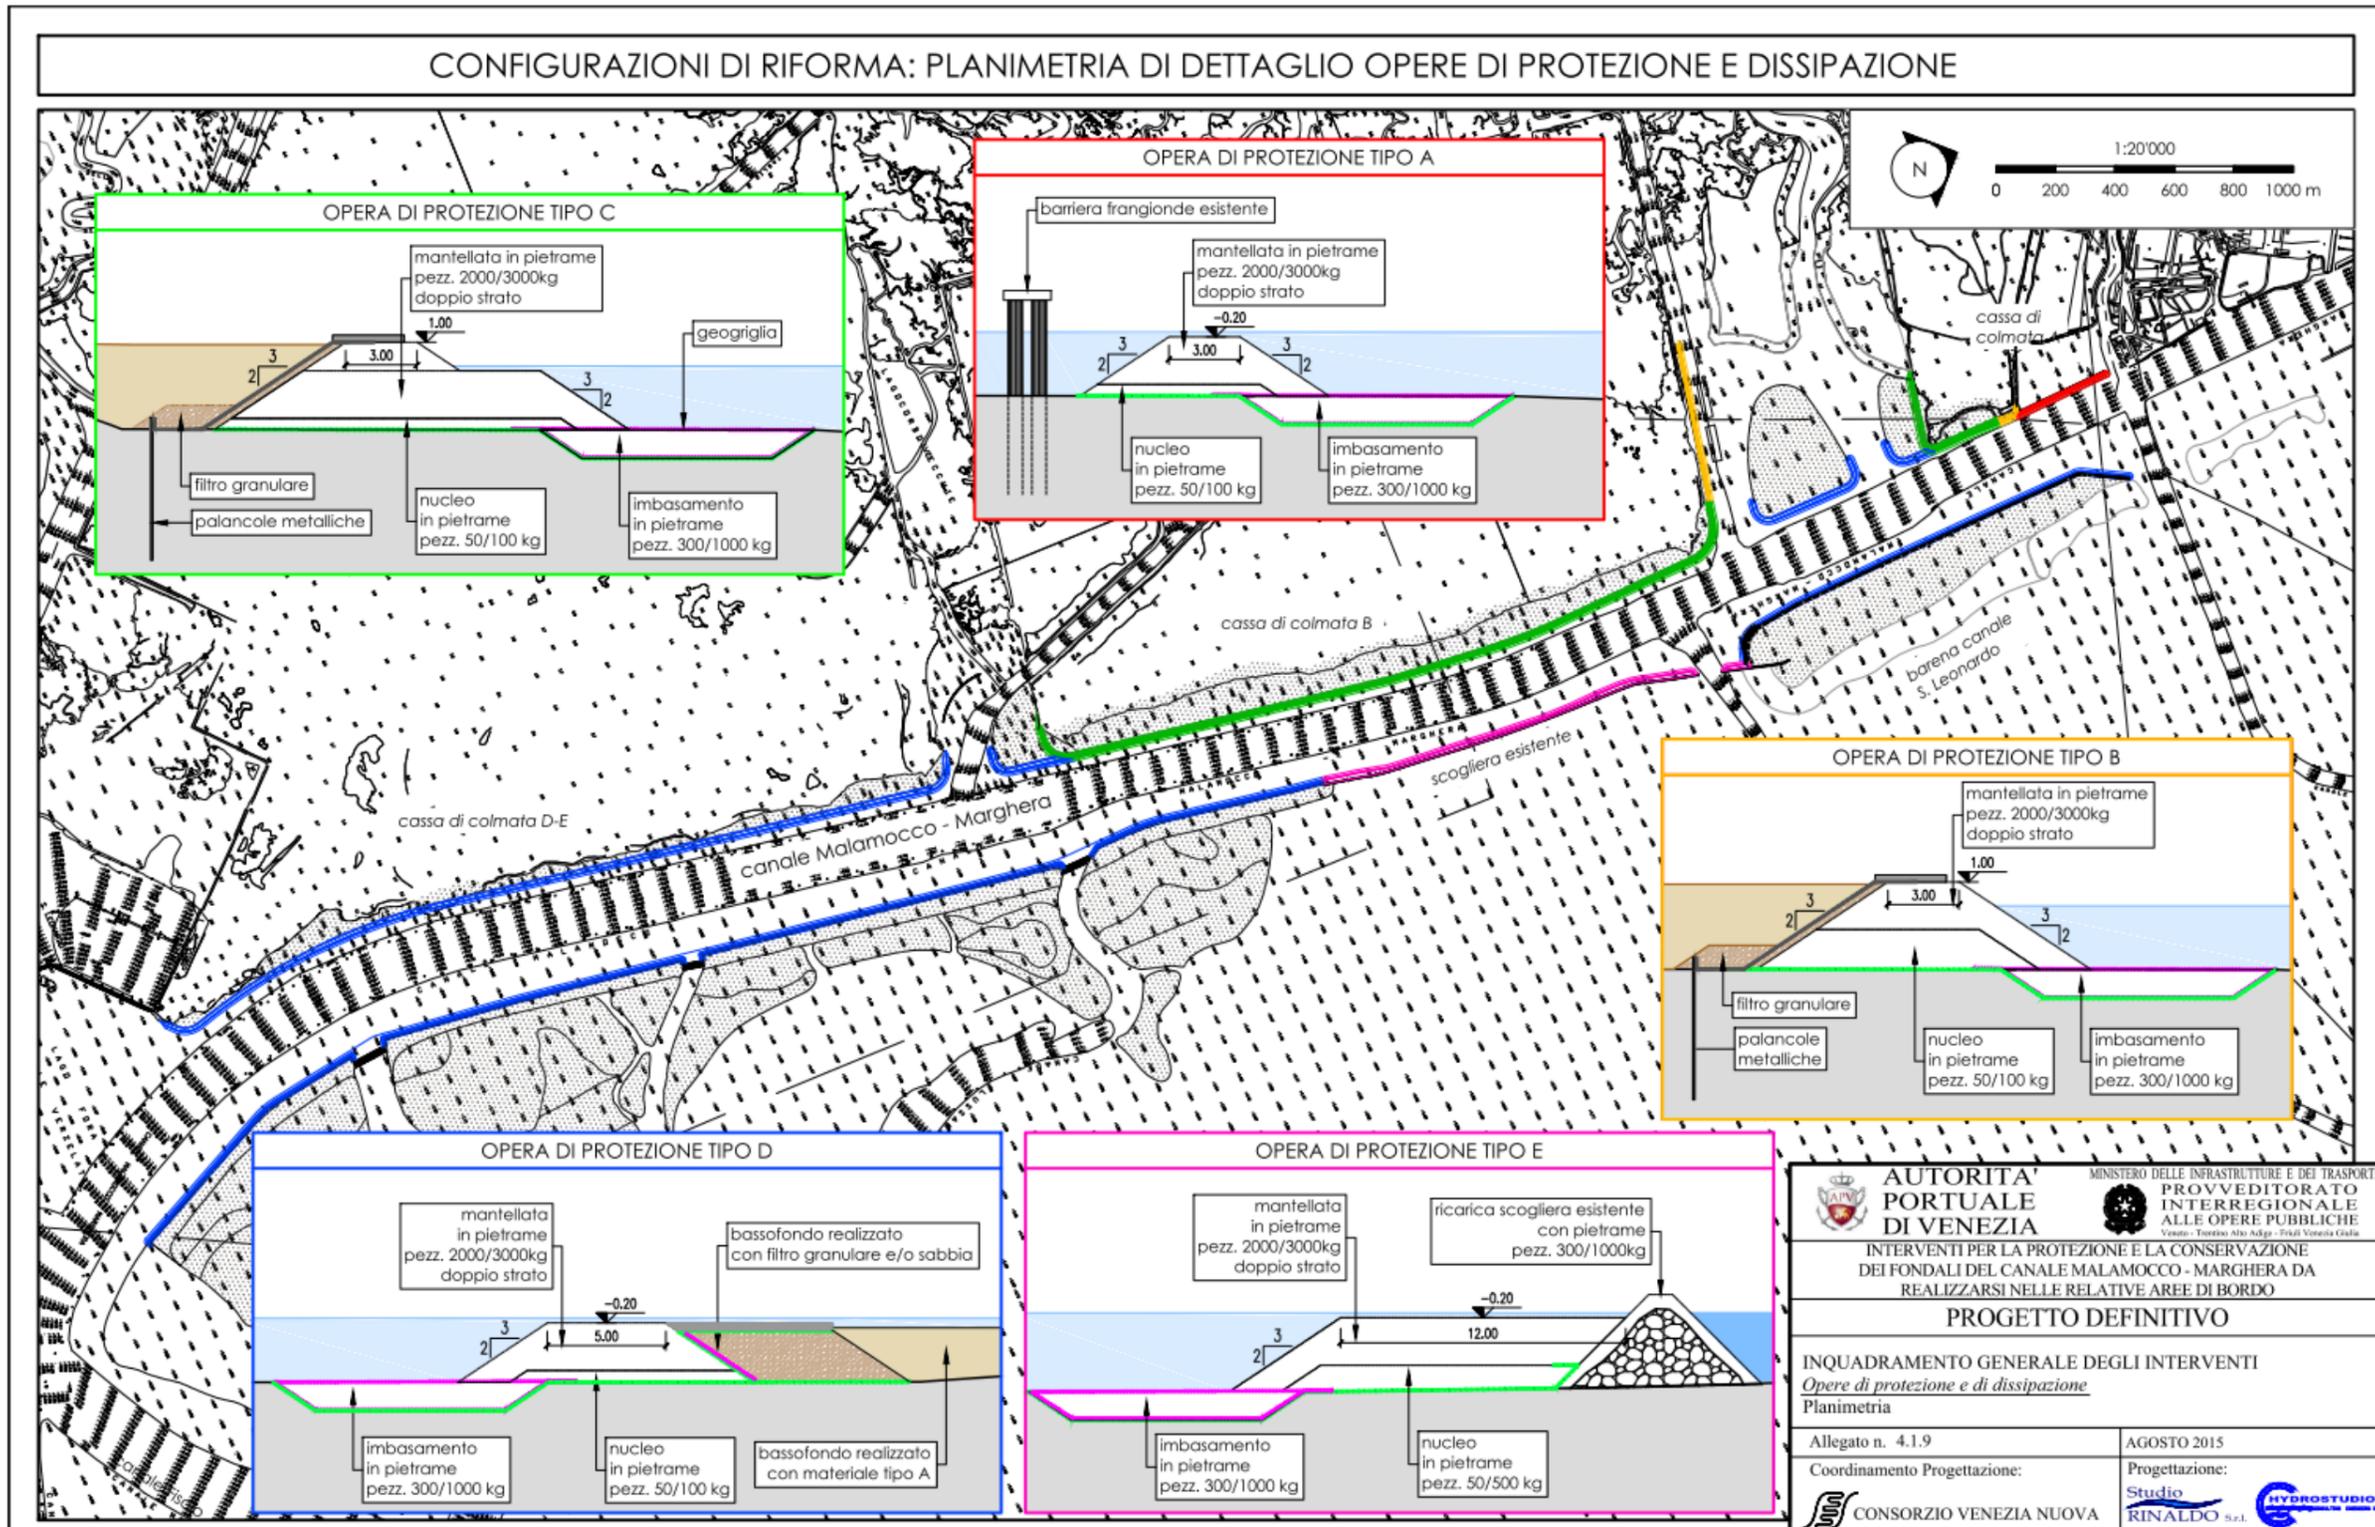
Planimetrai di dettaglio opere di protezione e dissipazione
